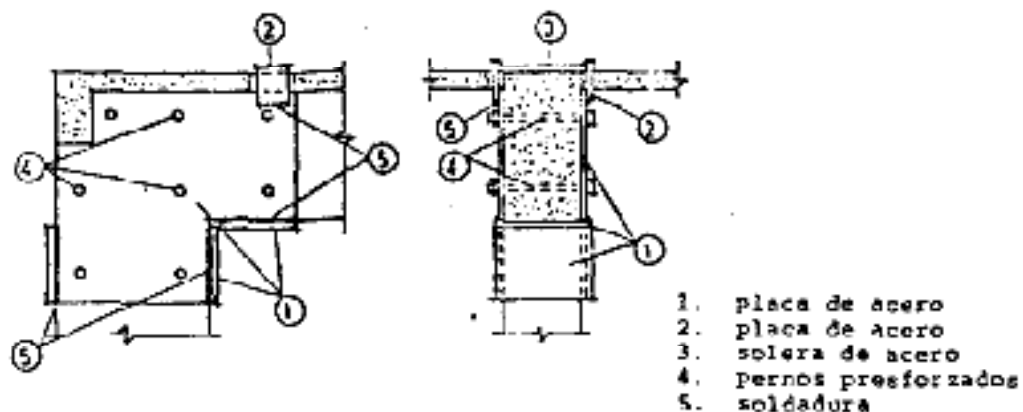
Encamisado metálico de una unión viga-columna (ref. 1)
